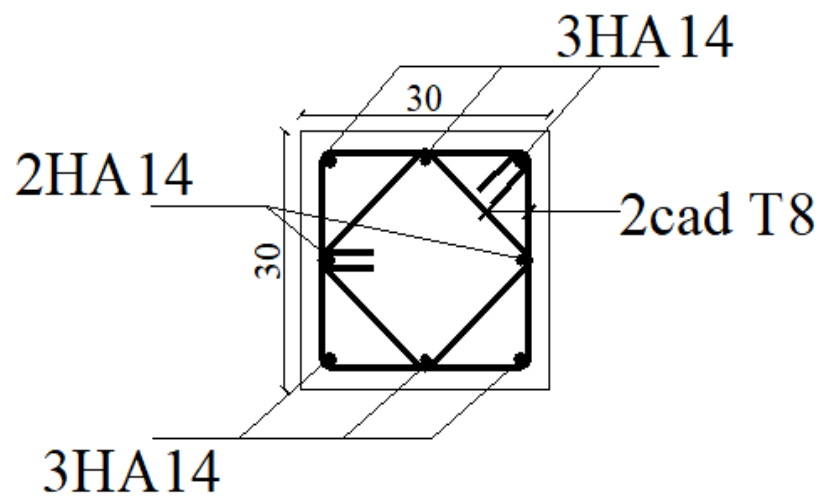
Ferrailage des poteaux 30 x 30
